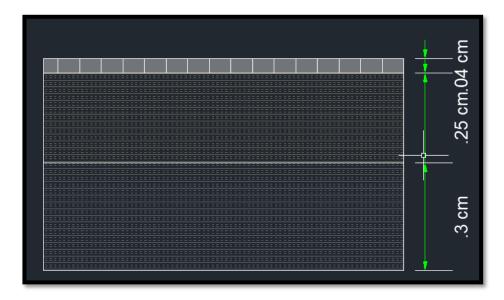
Paquete estructural del pavimento adoquinado(Elaboración propia)
